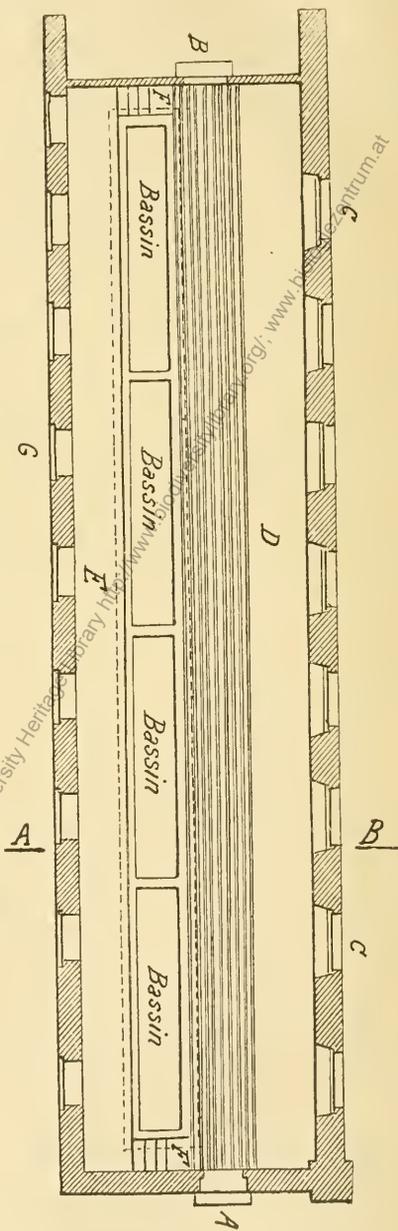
Grundriss des Orchideenhauses in Ferrières.
